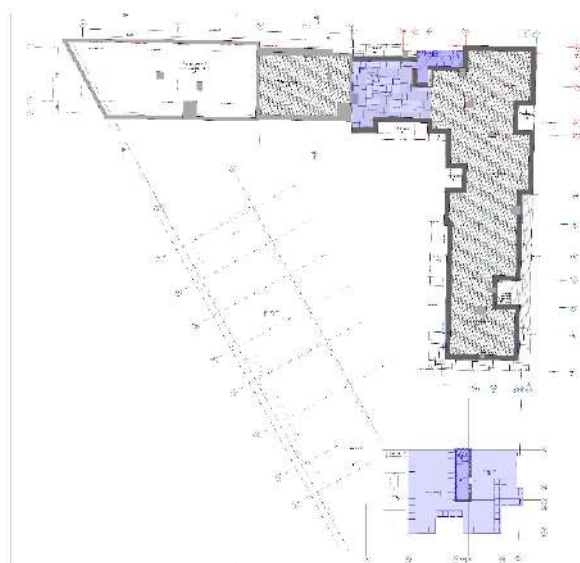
En bleu emplacement des toitures potagères (fond de plan issu de ADRIANA, annotations personnelles)
